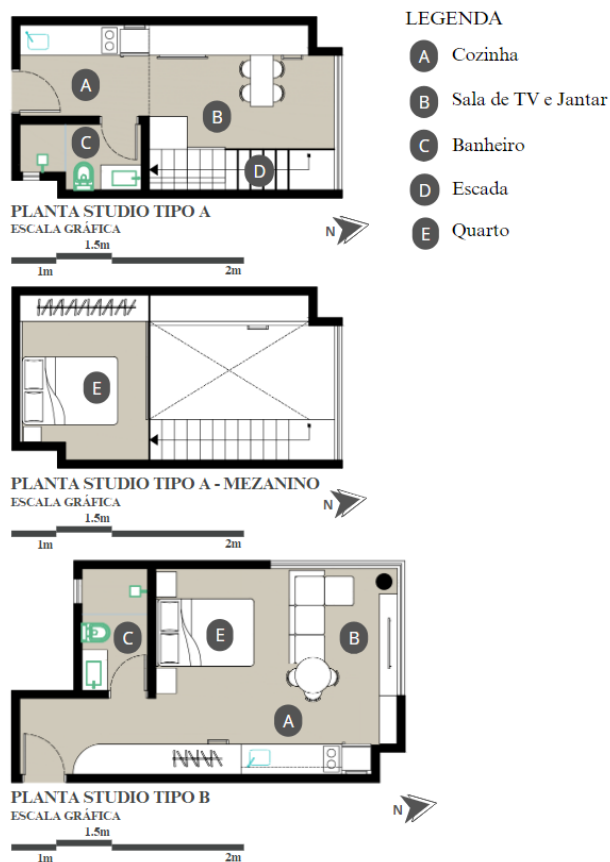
Planta baixa pavimento tipo mezanino 03, 04, 06 e 07.
